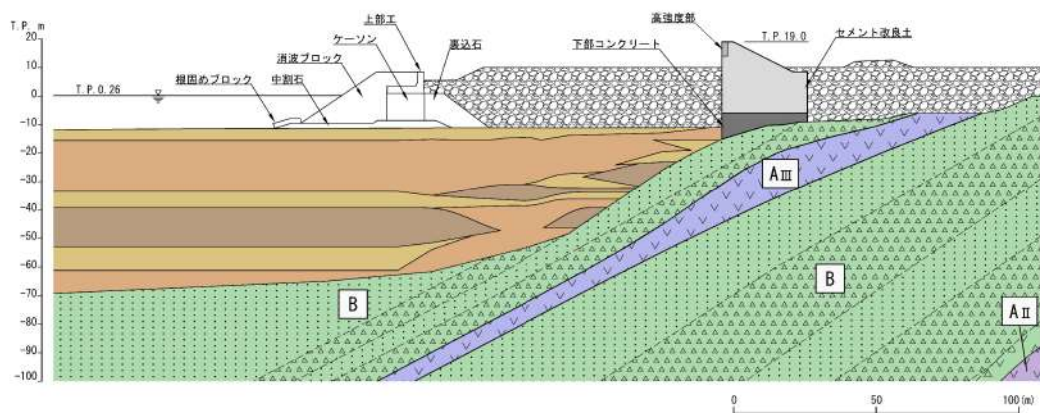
c.b-10 地質断面図 (B-B' 断面)
